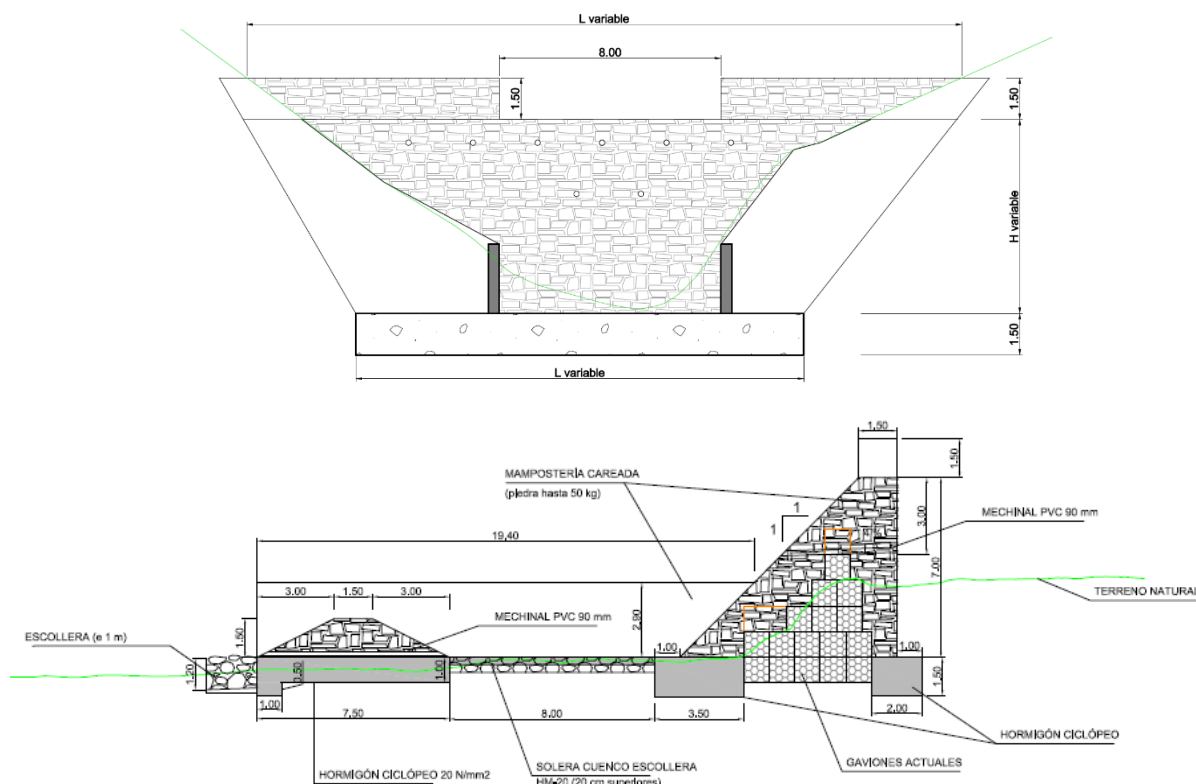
Alzado y sección de recrecimiento de diques mediante mampostería (sección dique 1)
